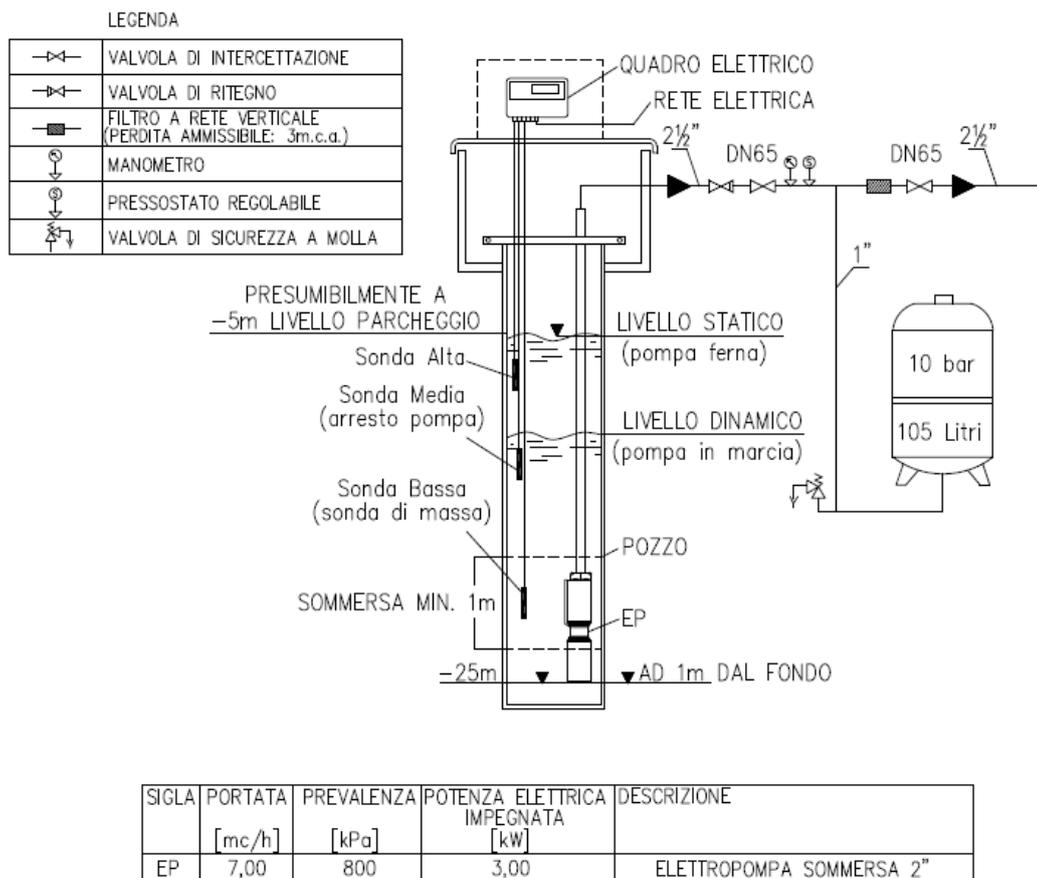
Schema della centrale di pressurizzazione di un impianto di innaffiamento con pozzo di irrigazione (Stralcio tavola IdEplm002.a)
